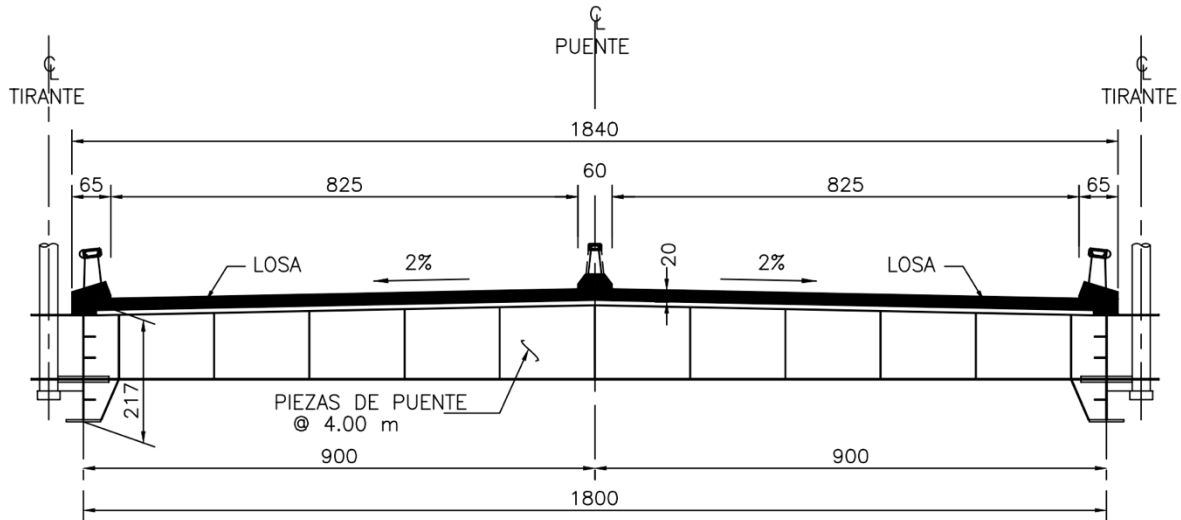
Sección transversal del tablero en Pila No. 2. [cm]
